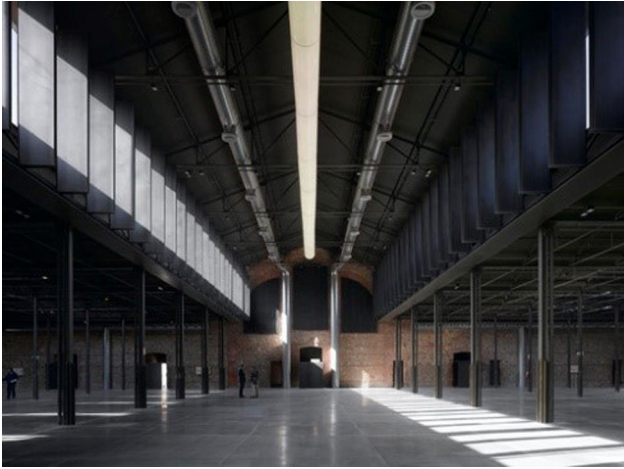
Vista interior de la estructura metálica rehabilitada nave 16.
